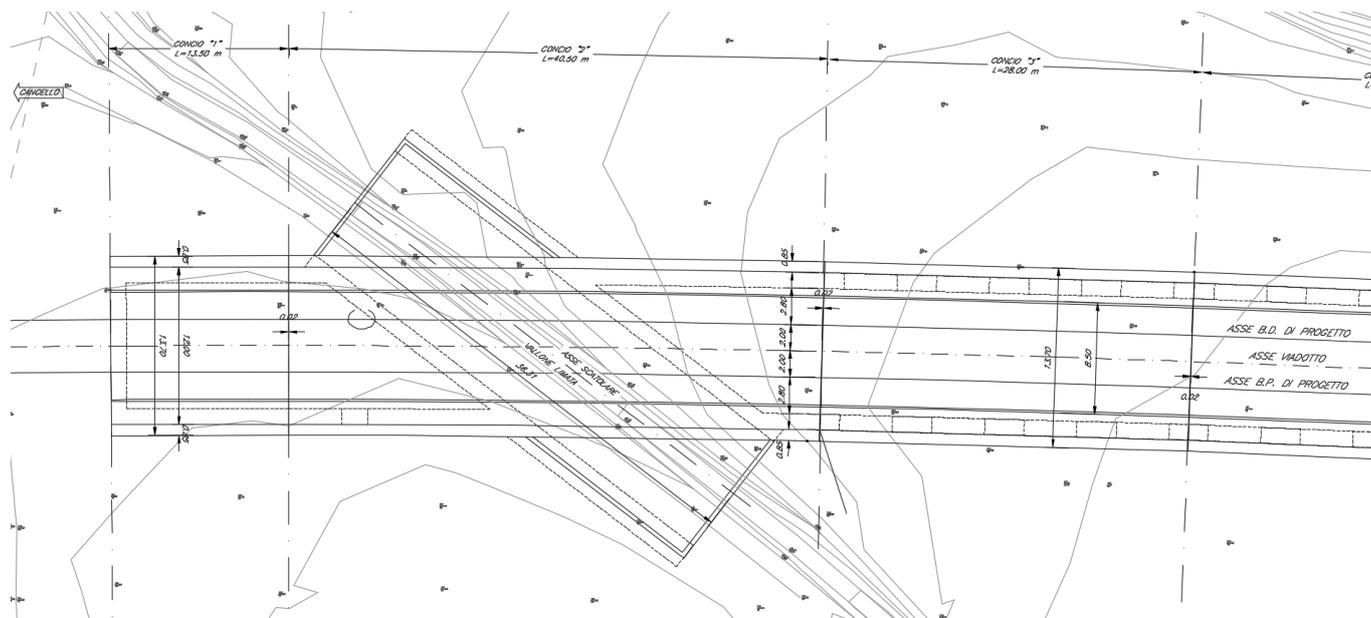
Stralcio planimetrico del VI14 – 1 di 2
